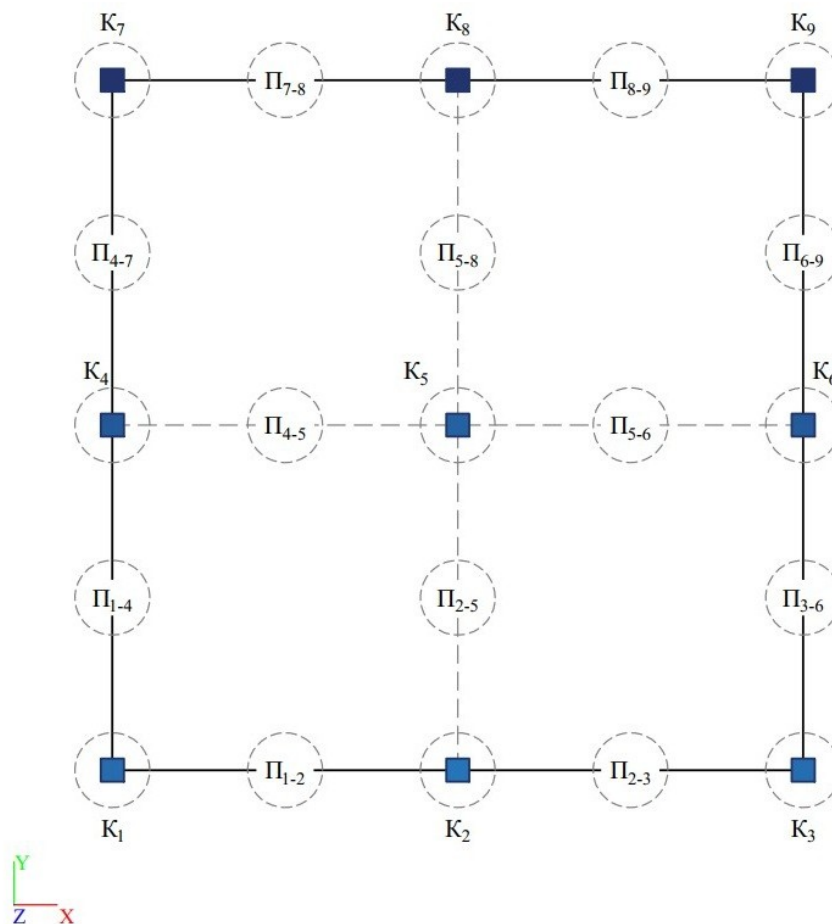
Схема расчетных зон плиты перекрытия:
